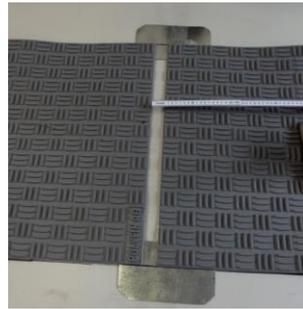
Nächste Platte mit 4 cm Abstand verlegen und genauso verfahren. Zug um Zug sämtliche Quernähte aller des Wartungsweges so aufschweißen.
